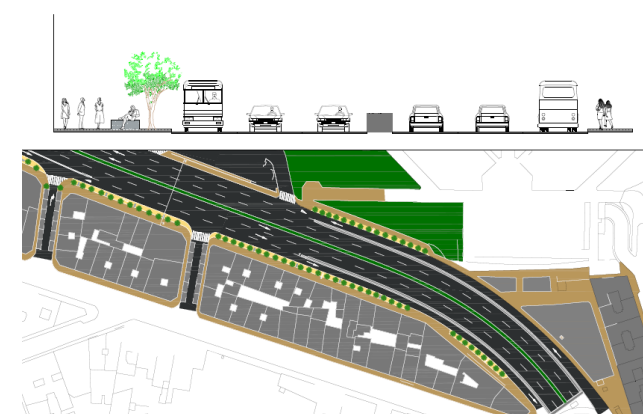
Planta y sección Avenida del Ejército, Os Castros.
